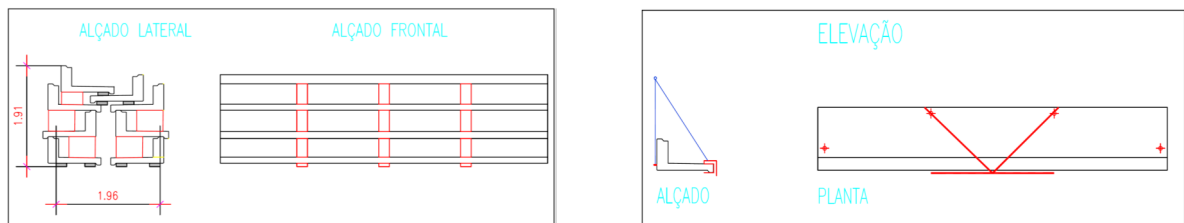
, 4.31– Pormenor de execução dos pré fabricados
